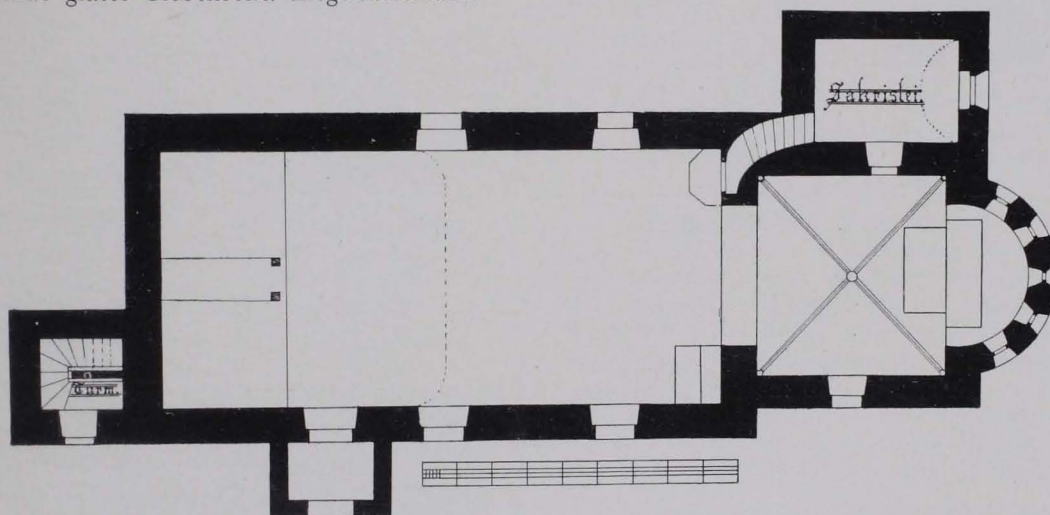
Niklasberg, Pfarrkirche, Grundriß 1:200 (S. 97)
